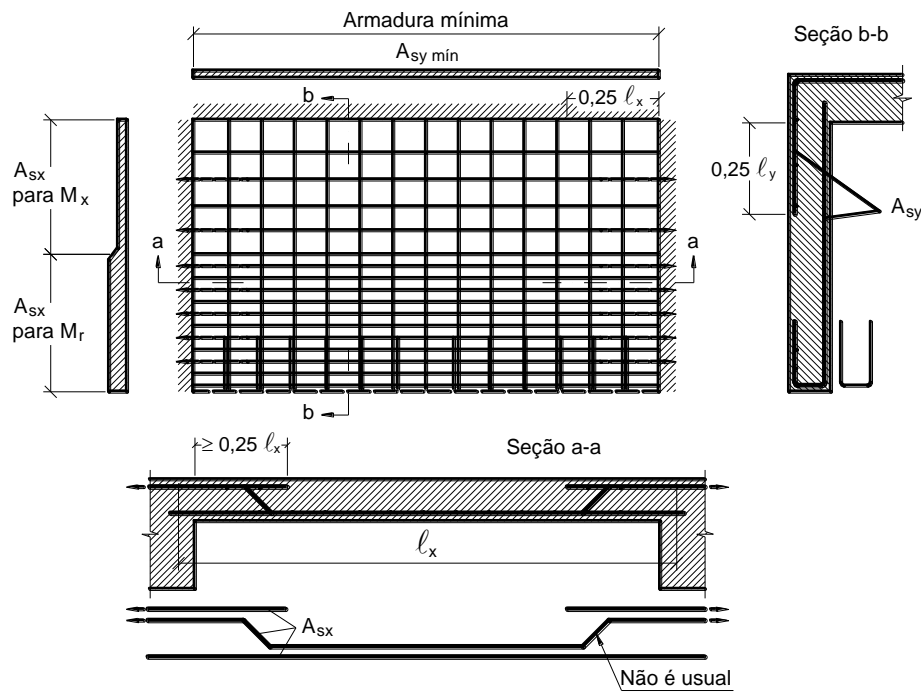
Armadura inferior de laje retangular apoiada em três lados engastados com carga uniforme.
